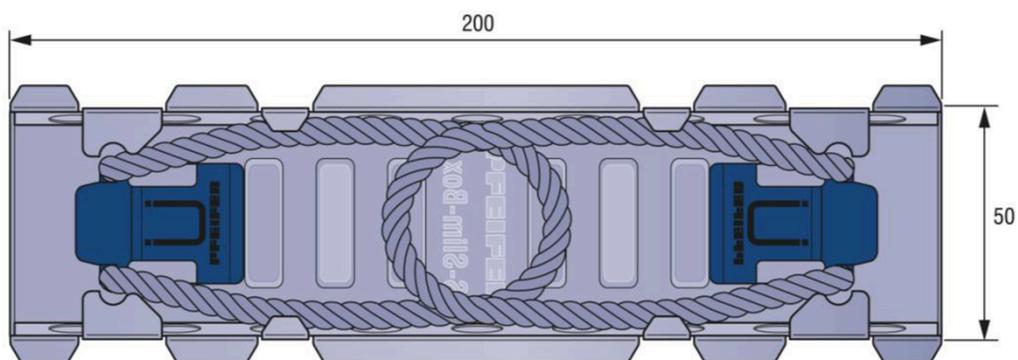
Draufsicht auf die geöffnete Box und die eingeklappten Seilschlaufen
